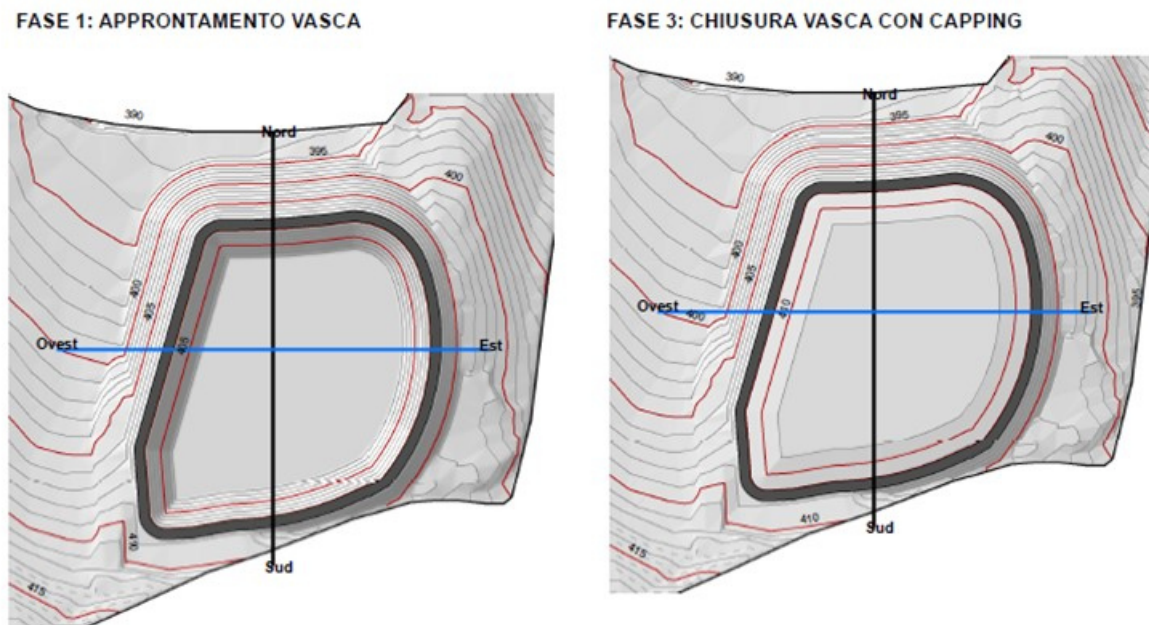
Ubicazione planimetrica sezioni Nord-Sud e Est-Ovest
